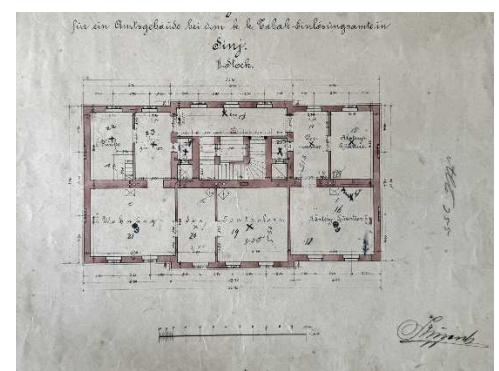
Grundriss des 2. Obergeschosses, Verwaltungsgebäude in Sinj.
